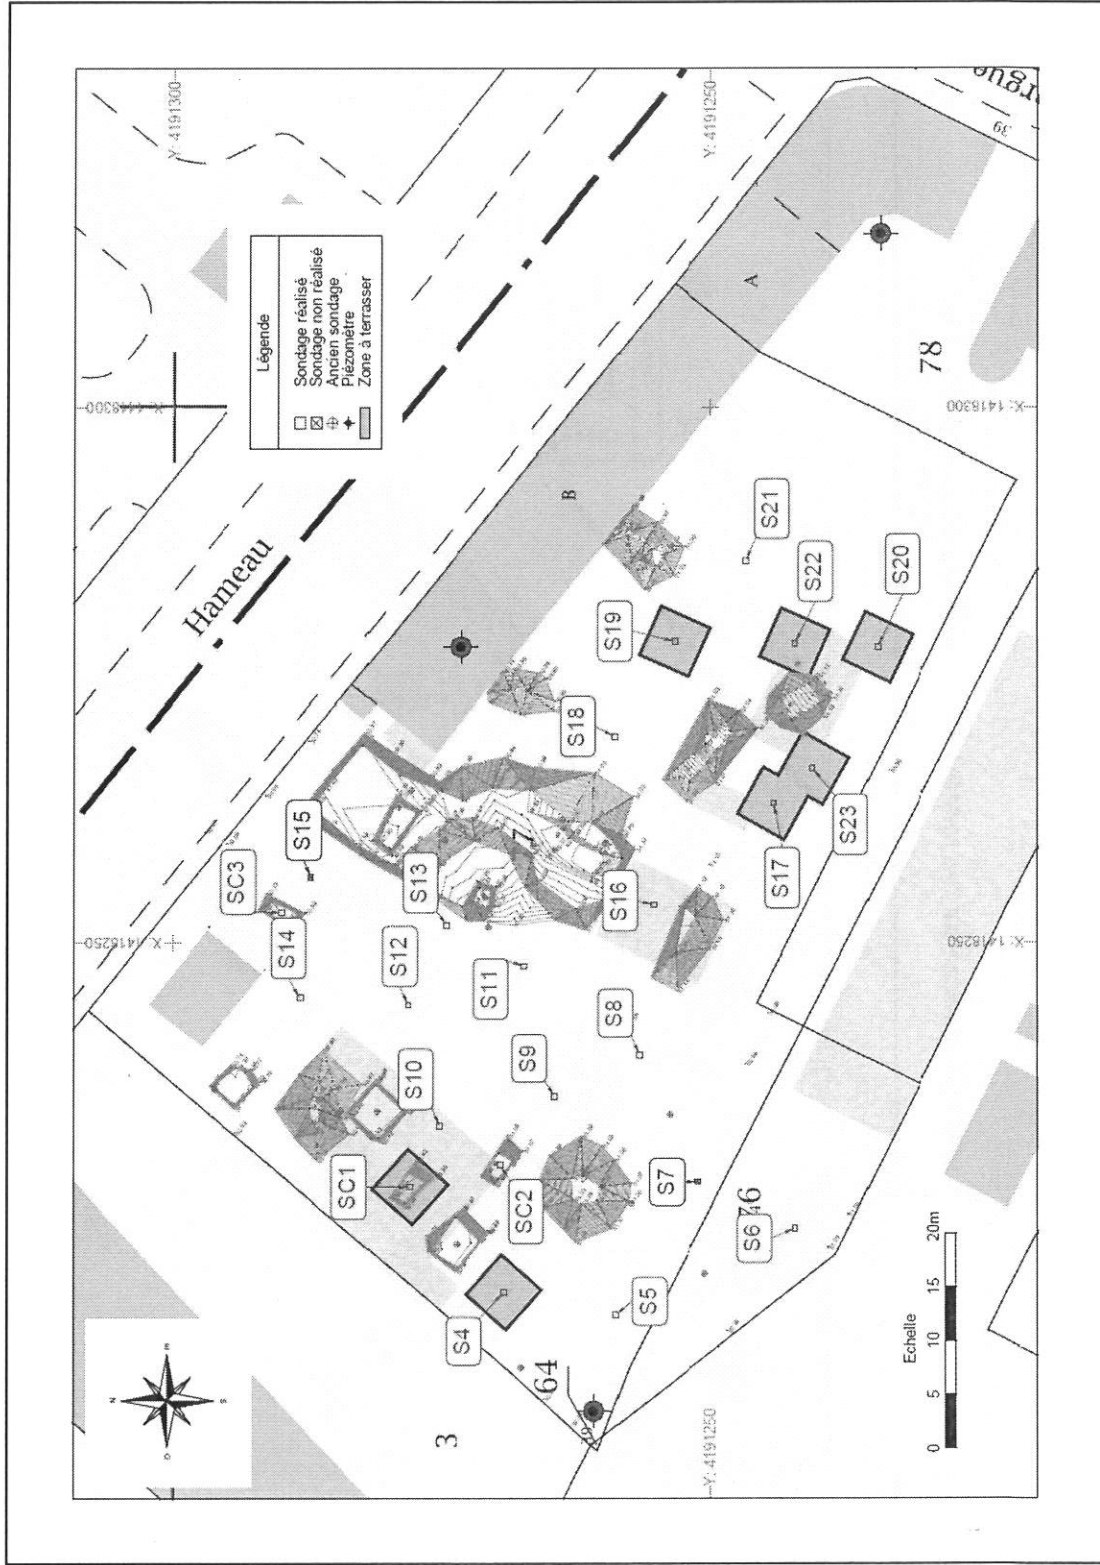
Plan de terrassement des remblais R2 (+/-1.00 à 2.00 m de profondeur)
